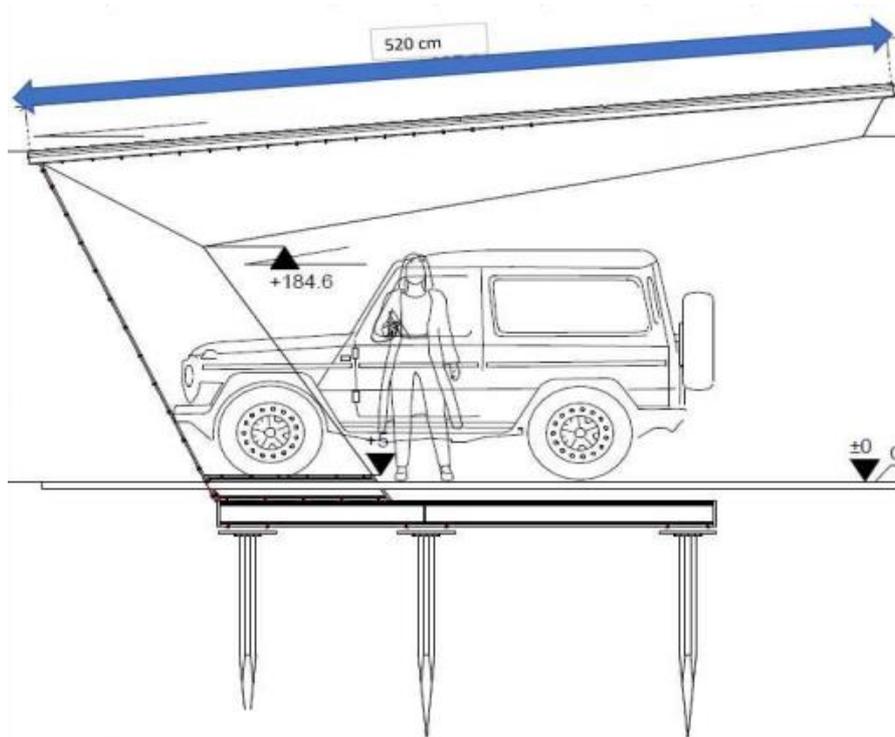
Schraubfundamentierung mit Stahlschwelle (© Swisscarport)
